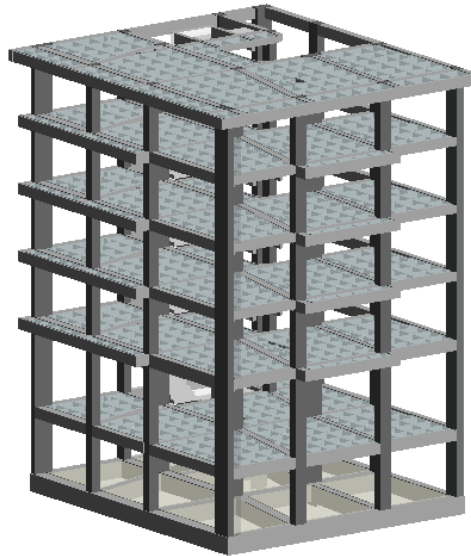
Diseño estructural. Vista en 3D del proyecto.
